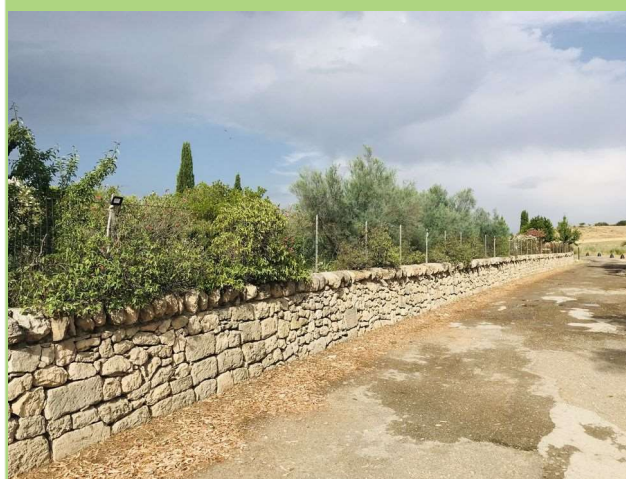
Muretto a secco (B.5.q) del Convento dei Battendieri.
